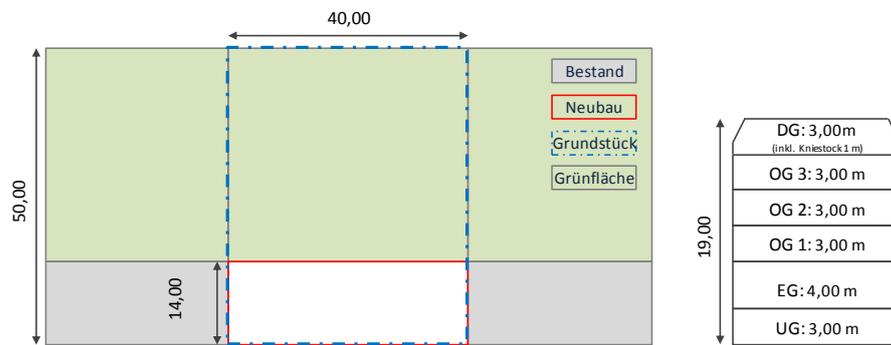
Projekt 1 – Grundriss und Geschosshöhen
